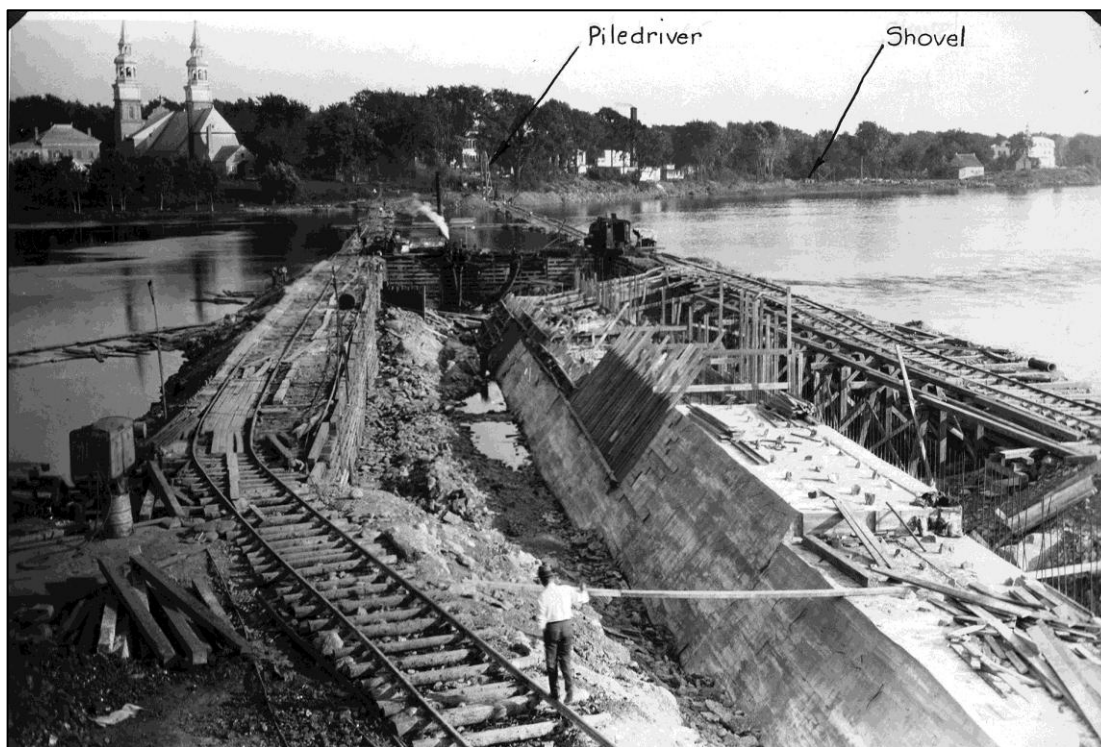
Construction plus avancée de la digue Simon-Sicard. Les caissons semblent avoir servi à la construction du rail sur la droite qui s'étendra ensuite sur la rive (HQ F09-701245-55-295).
